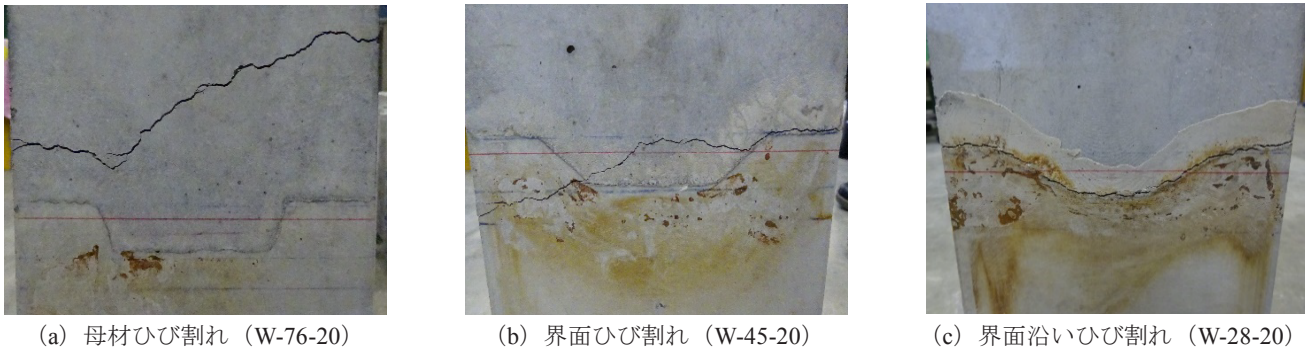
供試体引張作用側に発生したひび割れの種類
